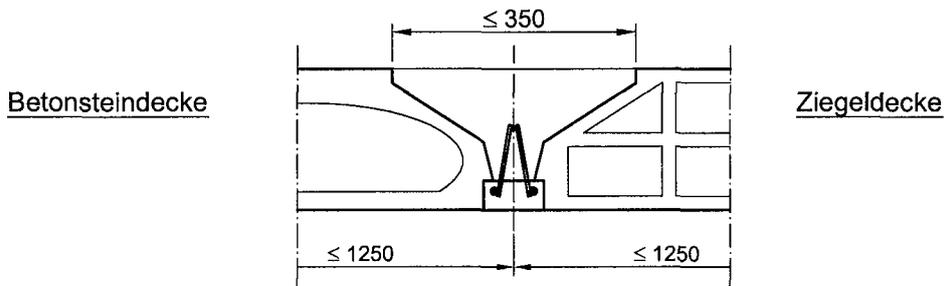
Rippendecke nach Anlage 8, Abschnitt 5
